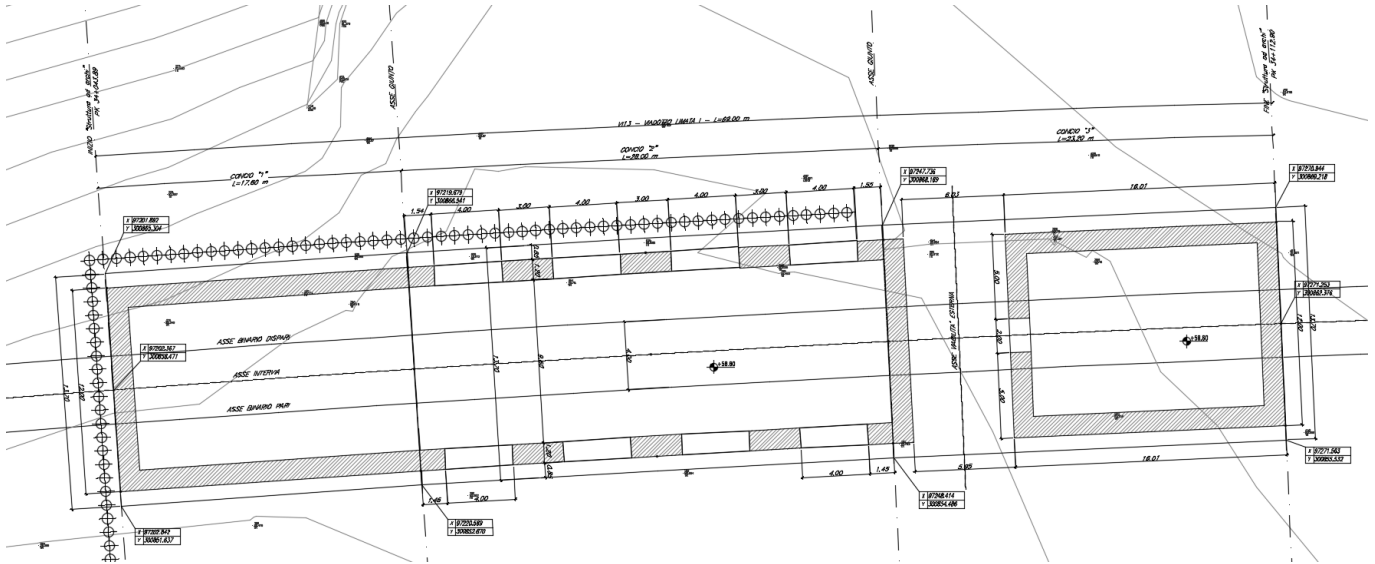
Stralcio pianta fondazioni del VI13 - “struttura ad archi”
